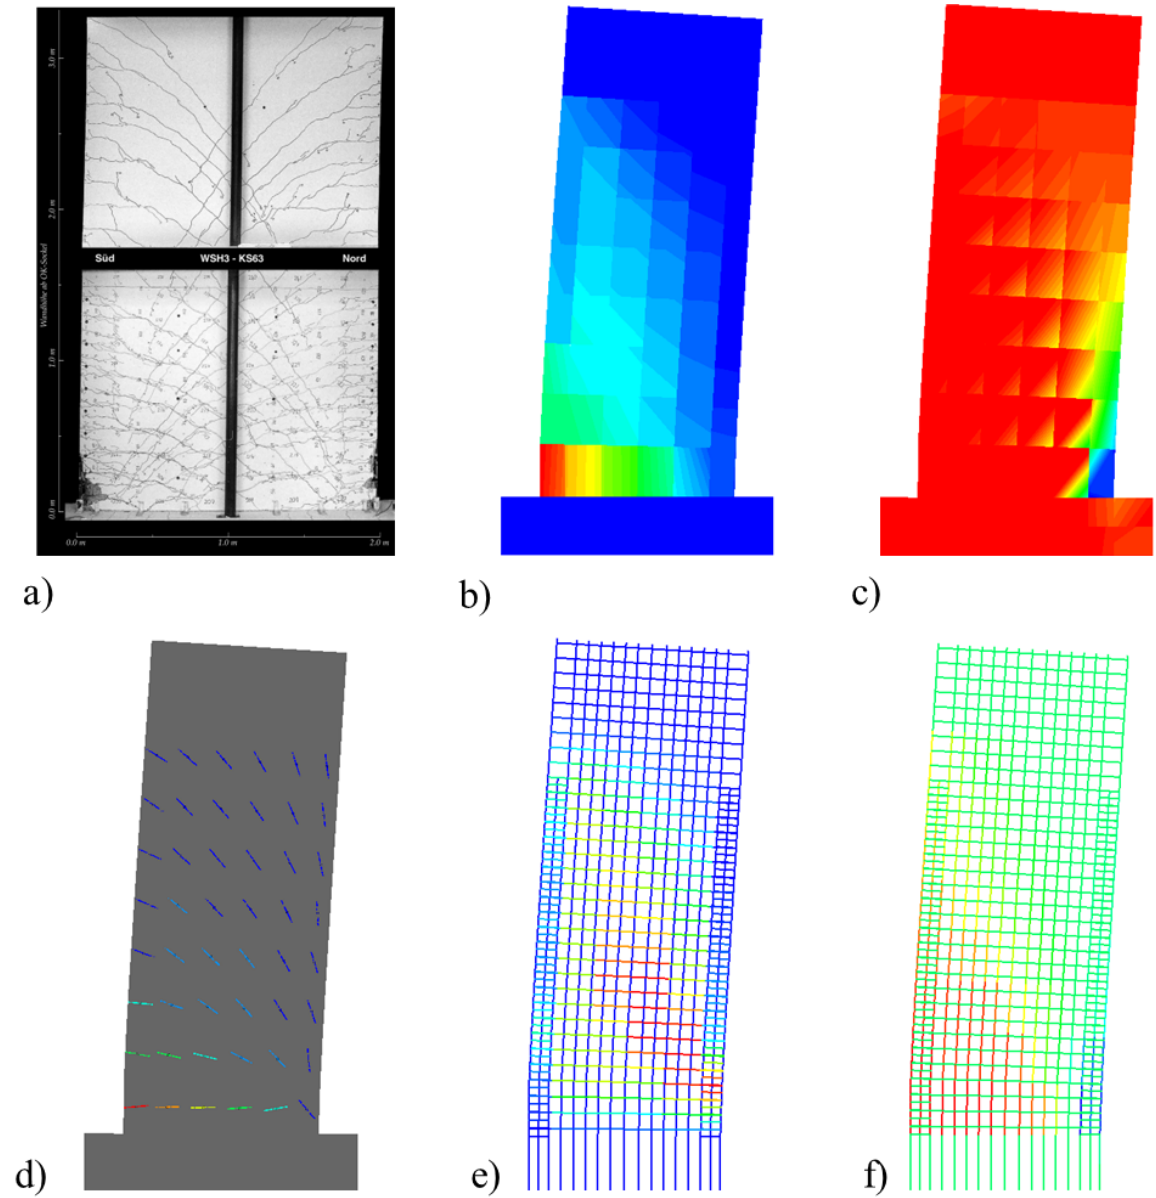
Comparación del estado de esfuerzos en el muro G cerca del punto de falla, a) Patrones de fisuración durante el ensayo al momento de la falla, b) deformaciones principales de tensión en el concreto, c) esfuerzos principales de compresión en el concreto, d) patrones de fisuración estimados, e) esfuerzos axiales en el refuerzo horizontal y f) esfuerzos axiales en el refuerzo vertical
